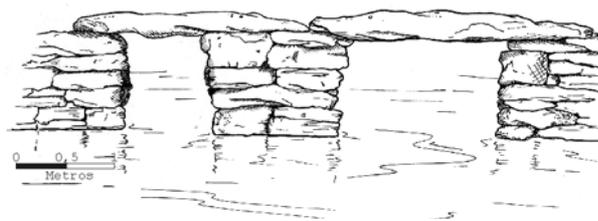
Alzado de la Pontella de Saa. Detalle de la pila central aguas abajo. Dibujo Luís Suárez
